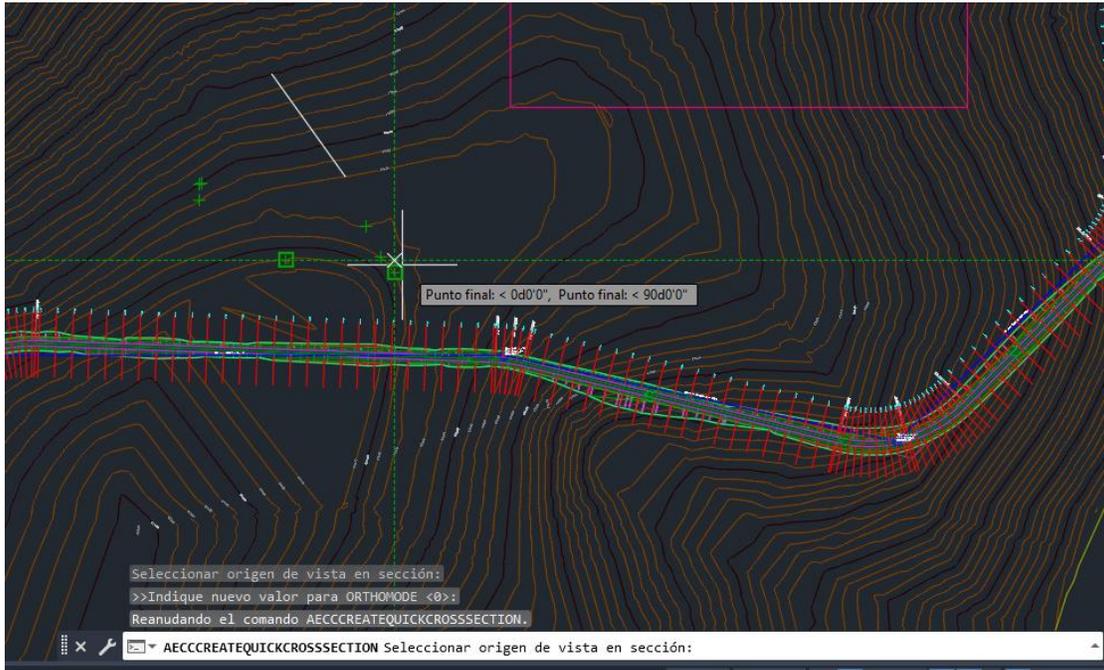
Indicación para seleccionar el punto de origen de la vista de la sección transversal
